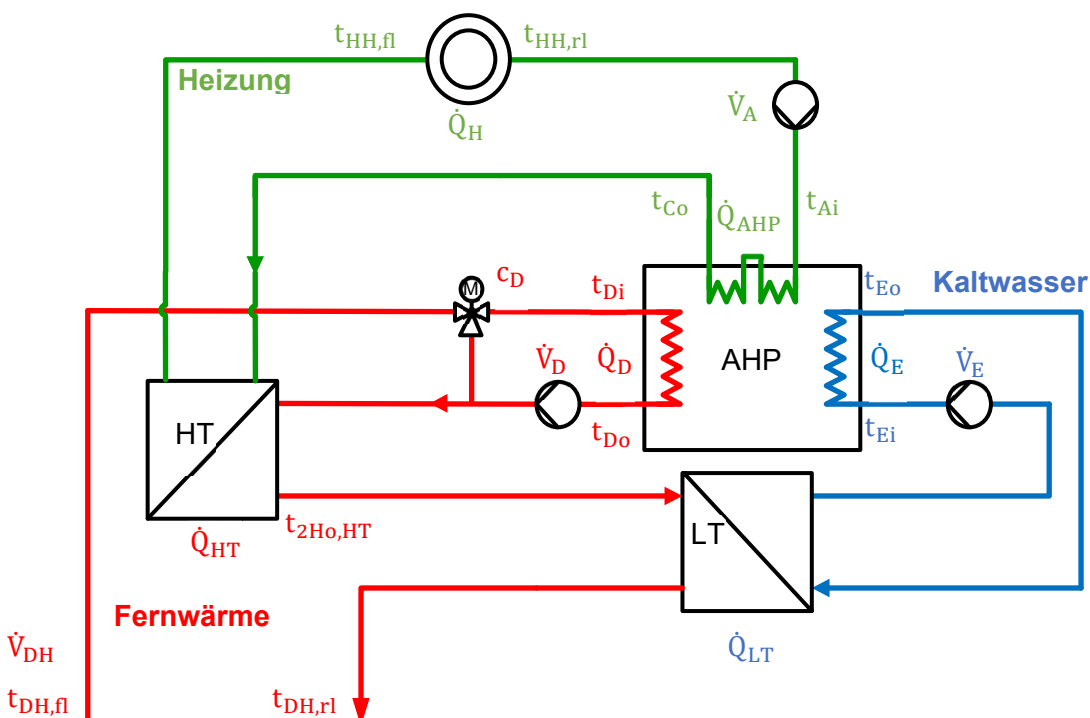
Hydraulischer Systemplan einer Absorptions-Hausanschlussstation
